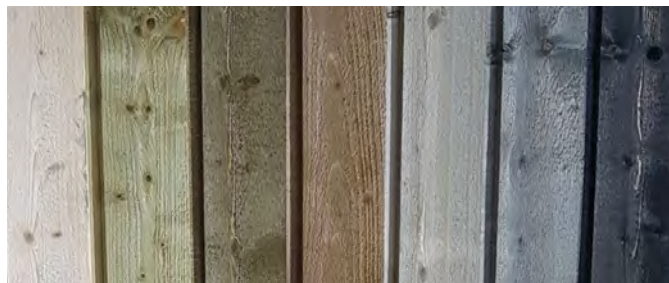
Voorbeeld van lelijke vergrijzing bij onbehandeld hout
